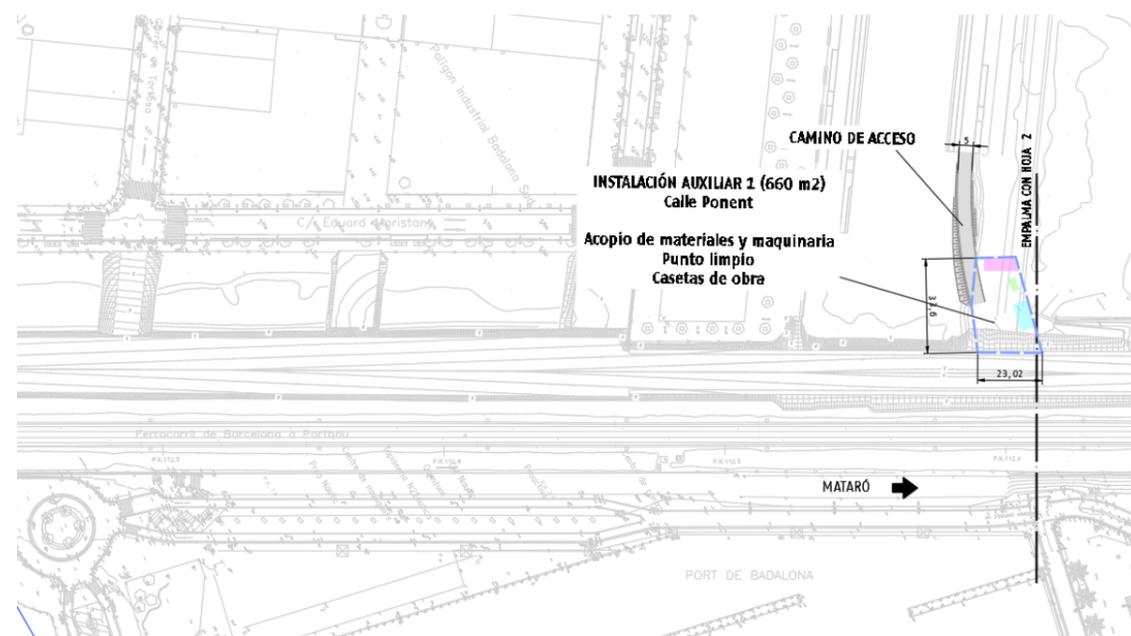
Implantación camino de acceso a obra e instalación auxiliar 1
